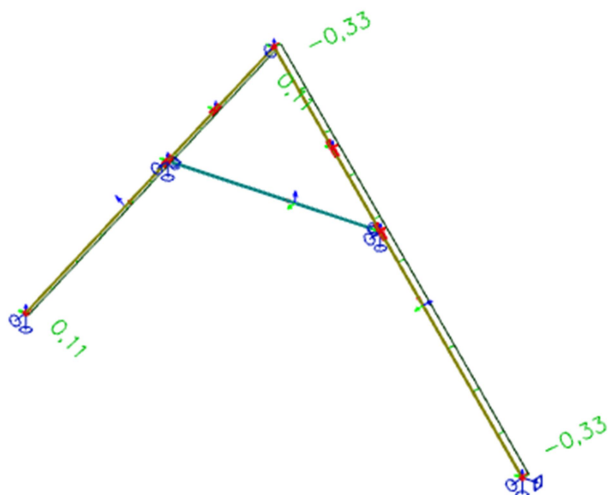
Konstrukce 3, Zatěžovací stav ZS5
